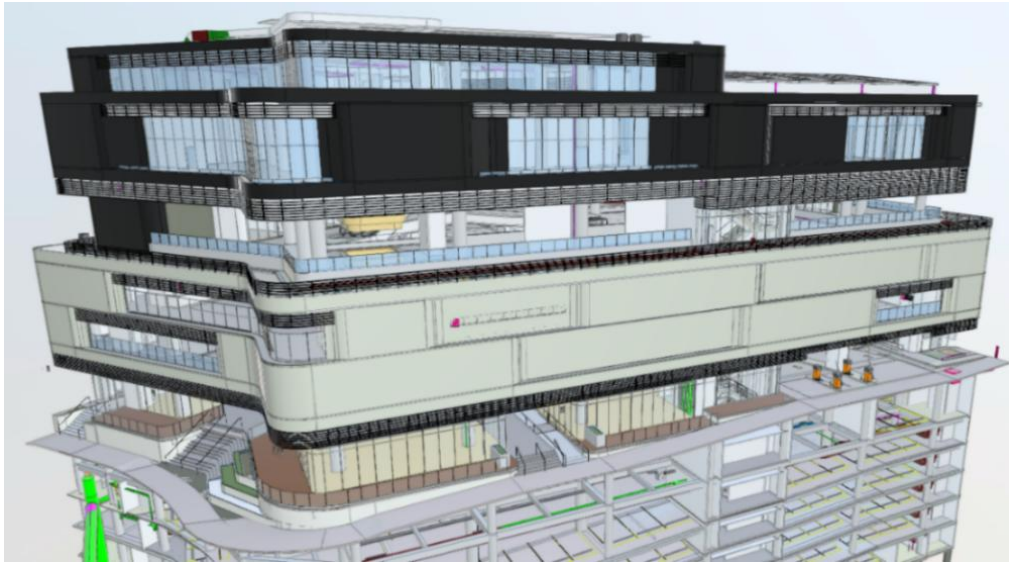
C.C. Plaza Videre - Fachada 19 Avenida A
